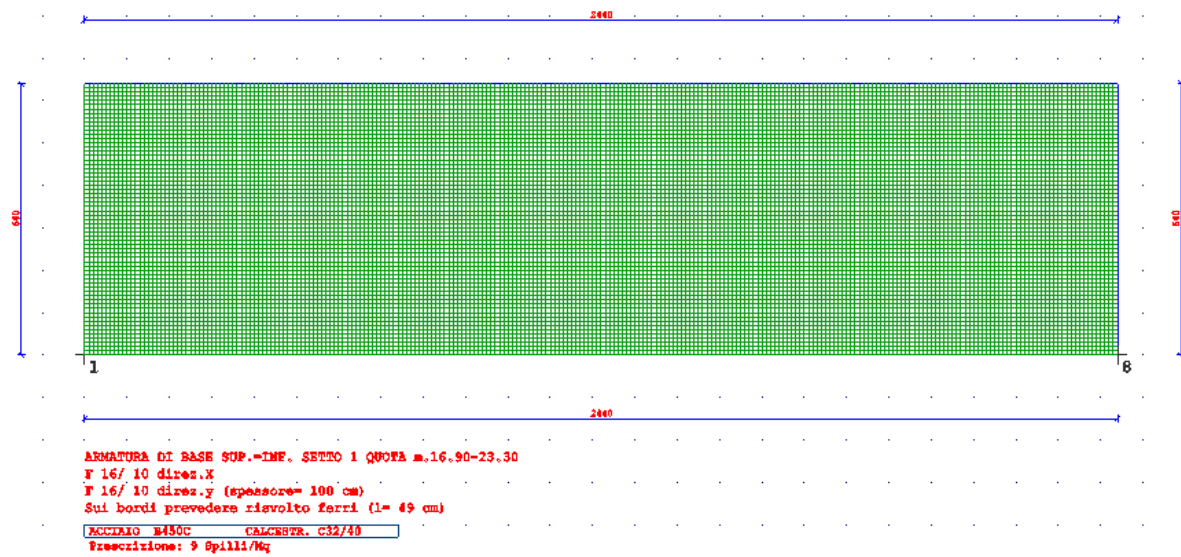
Armatura setto 1 alle quote strutturali indicate
